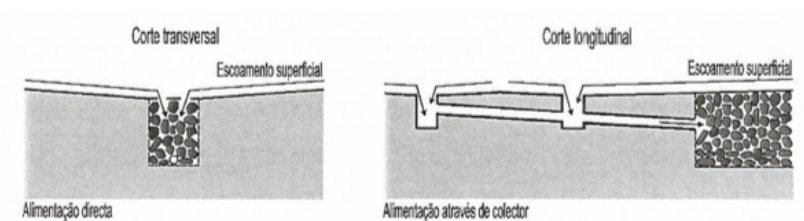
Tipos de alimentação de trincheiras de infiltração (Azzout et al, 1994).
